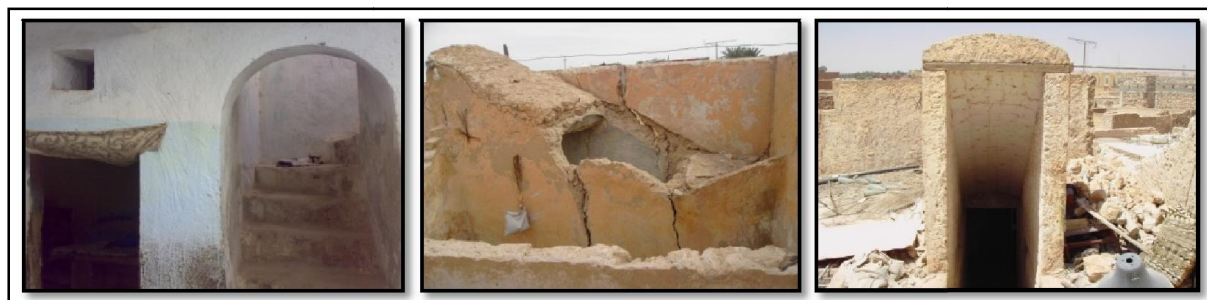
Structure apparente d'escalier sur paillasse en bois. Ksar de Ouargla. (Source : Auteur, 2015)
